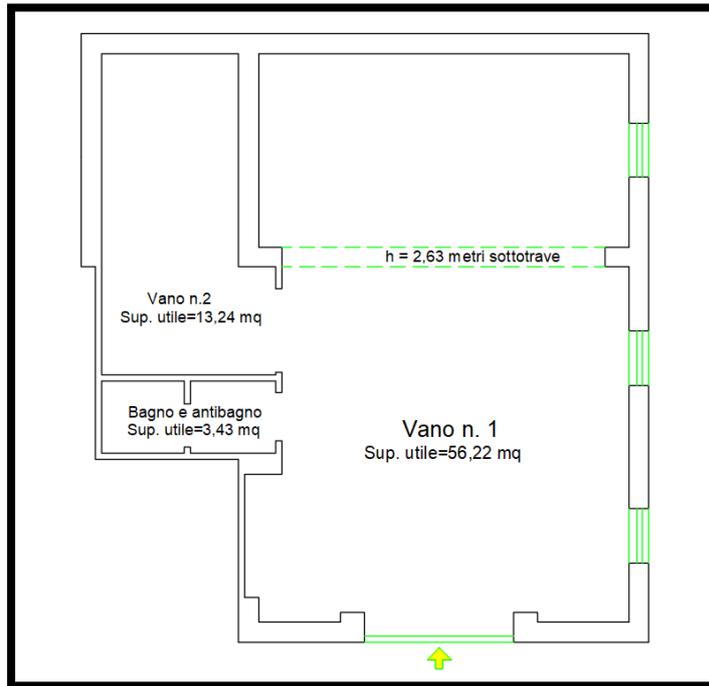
Pianta piano terra allegata alla SCIA pratica n. 19/2011 prot. n. 4673 10/06/2011
